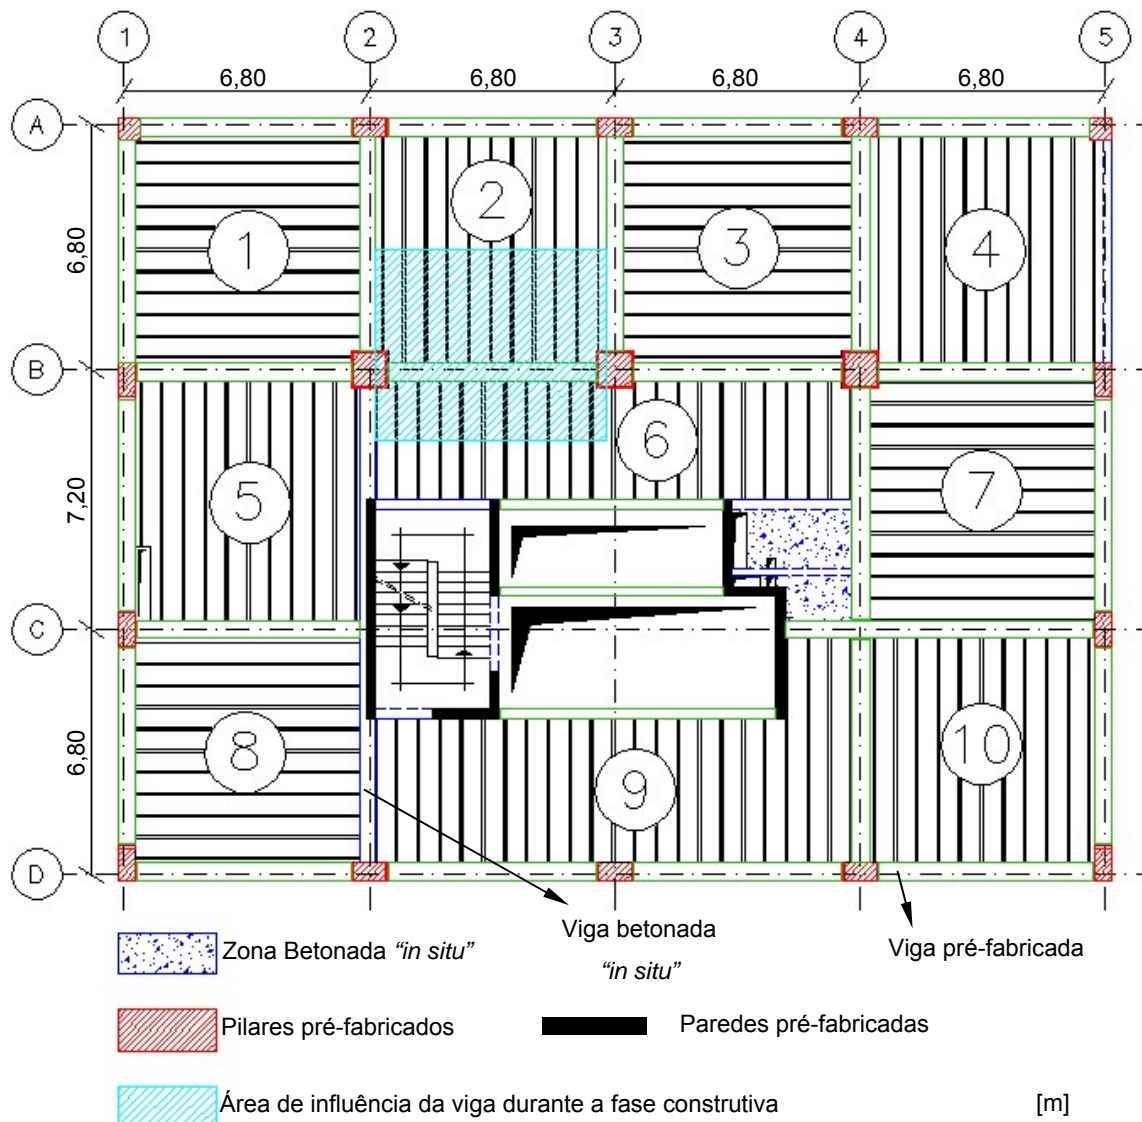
Disposição das pranchas de laje minos na planta do piso tipo
